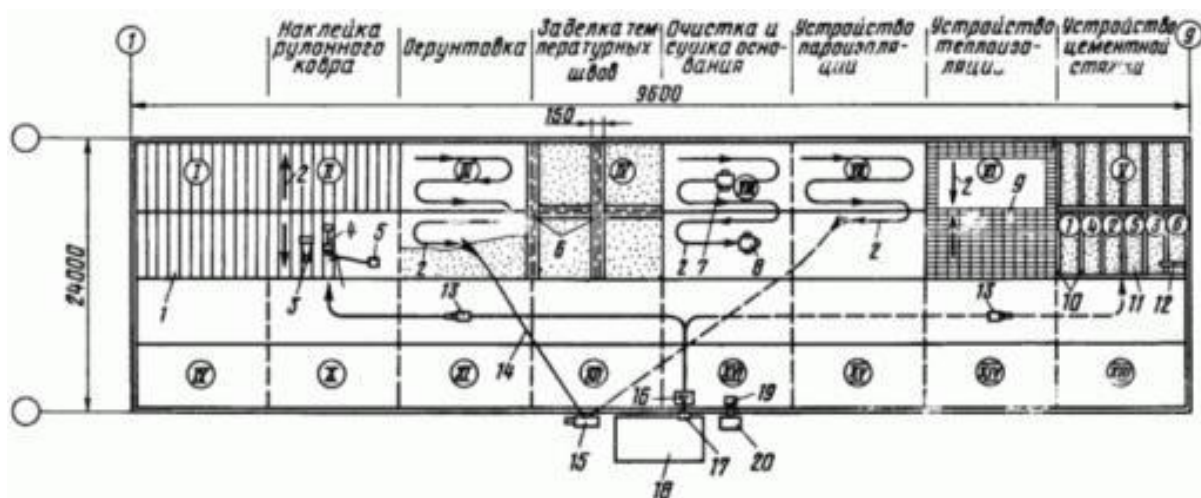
Схема производства работ. Уклон кровли 6-10 %
